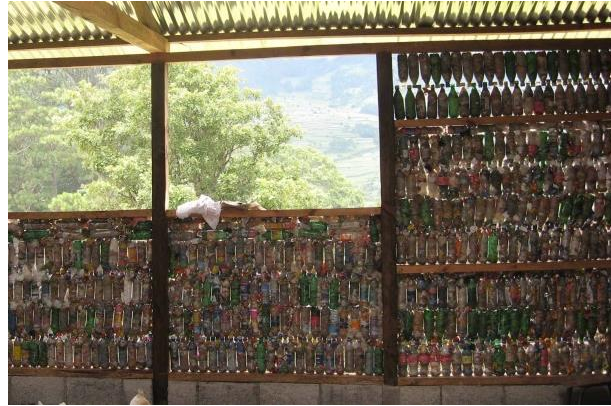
Sistema constructivo de muro de ecoladrillos verticales.
